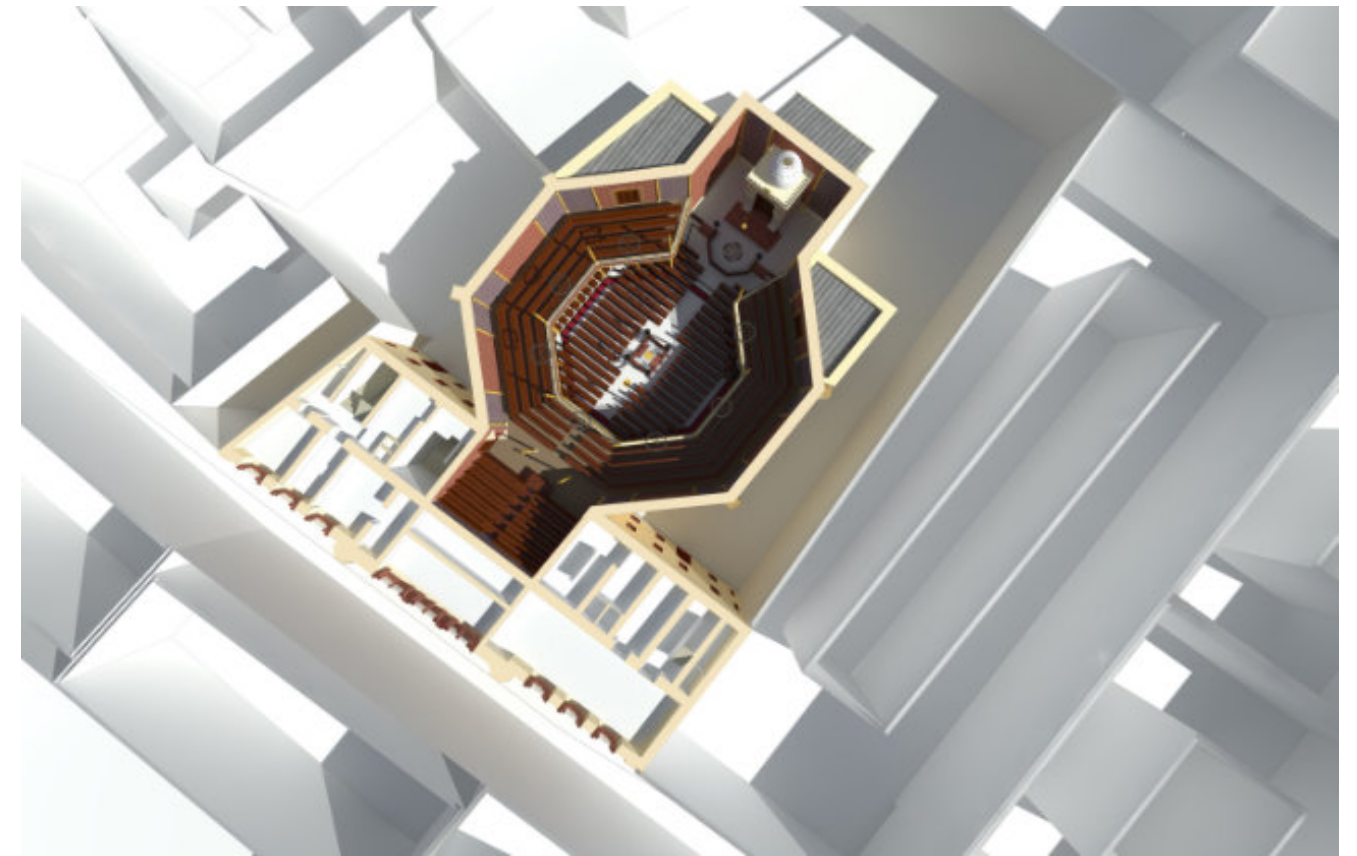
29.: 3D Grundriss - 1. Obergeschoß, Visualisierung.
